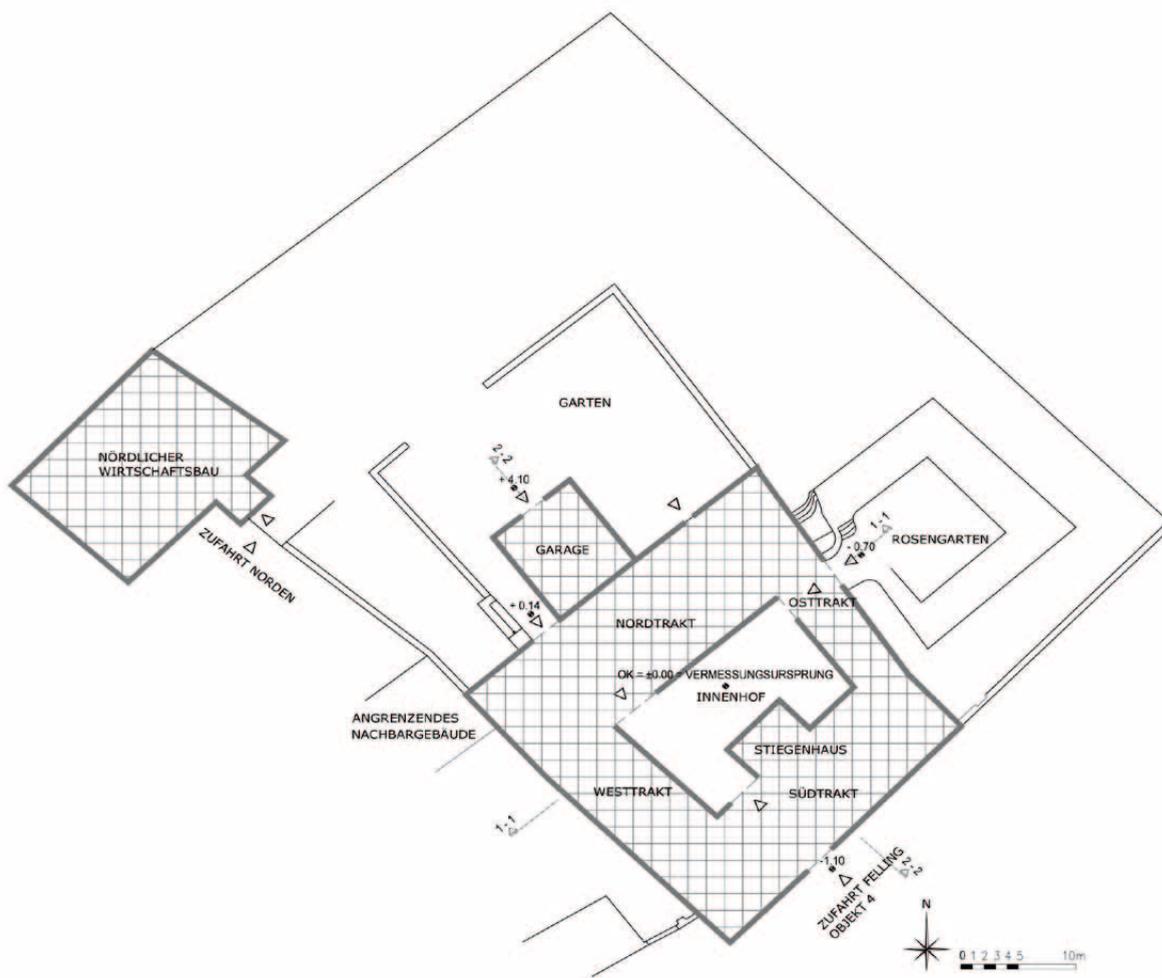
Vermessungsplan Lageplan mit Schnittführungen
